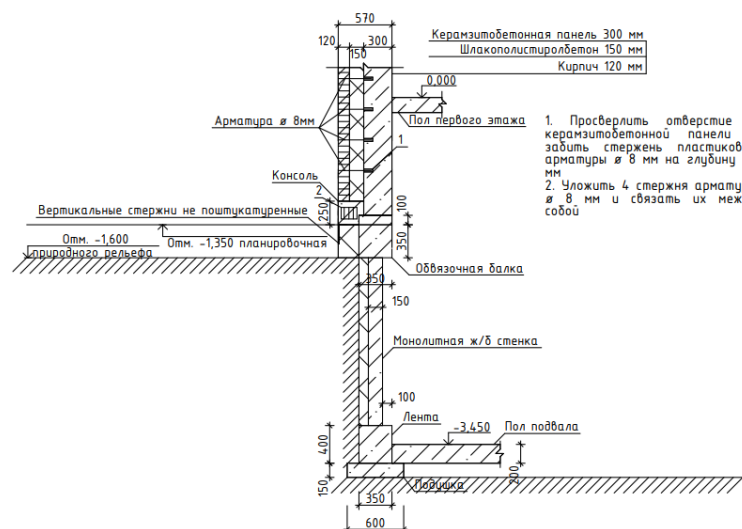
Вариант возведения фундаментной стены с применением несъемной опалубки
